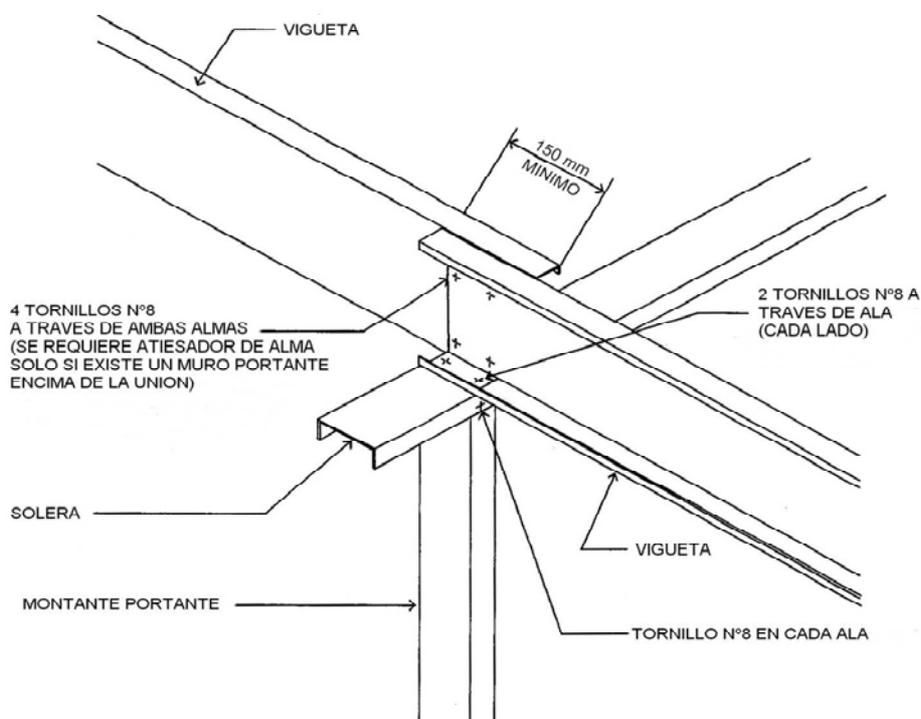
Detalle de empalme de viguetas para luces superiores a 4m o cuando sea necesario; Fuente MAnnual de Steel Framming
